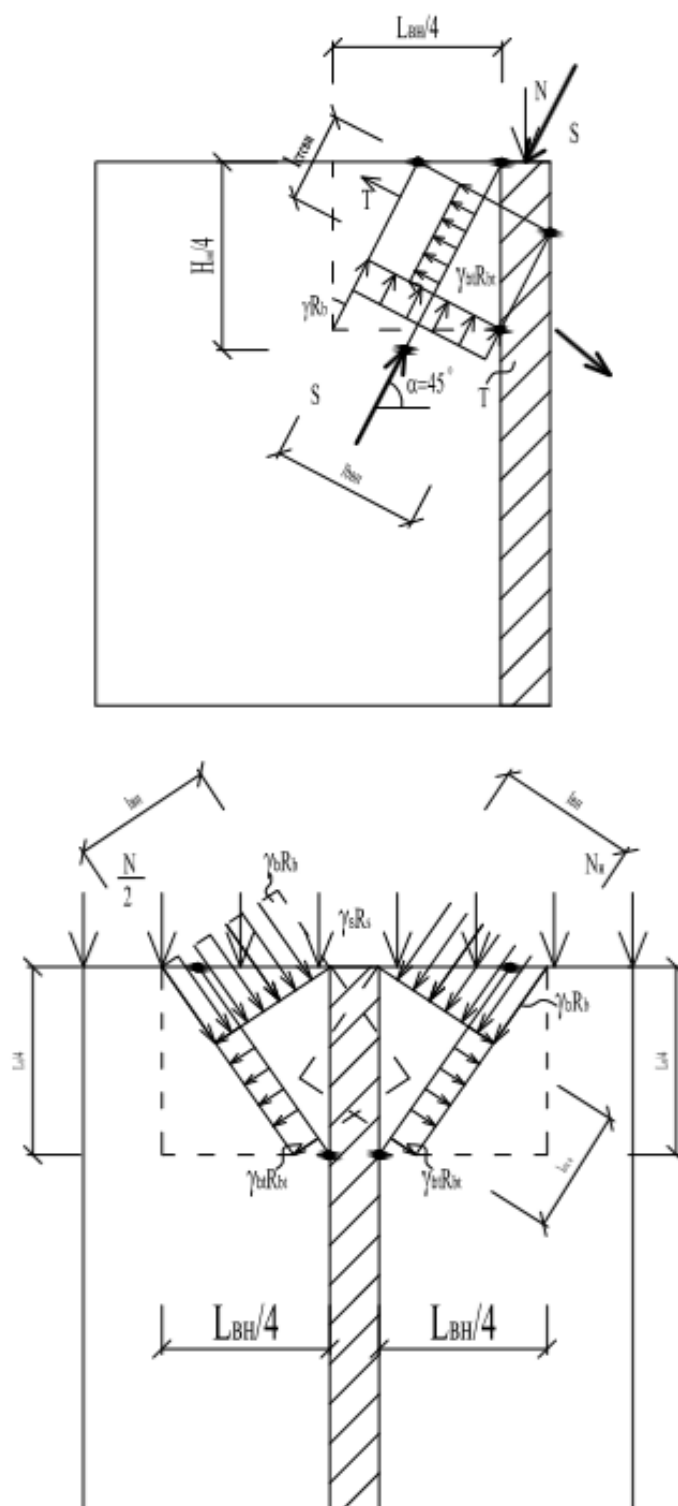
Расчетная схема узла сопряжения разнодеформируемых стен при нагружении наружной стены на основе каркасно-стержневой модели
